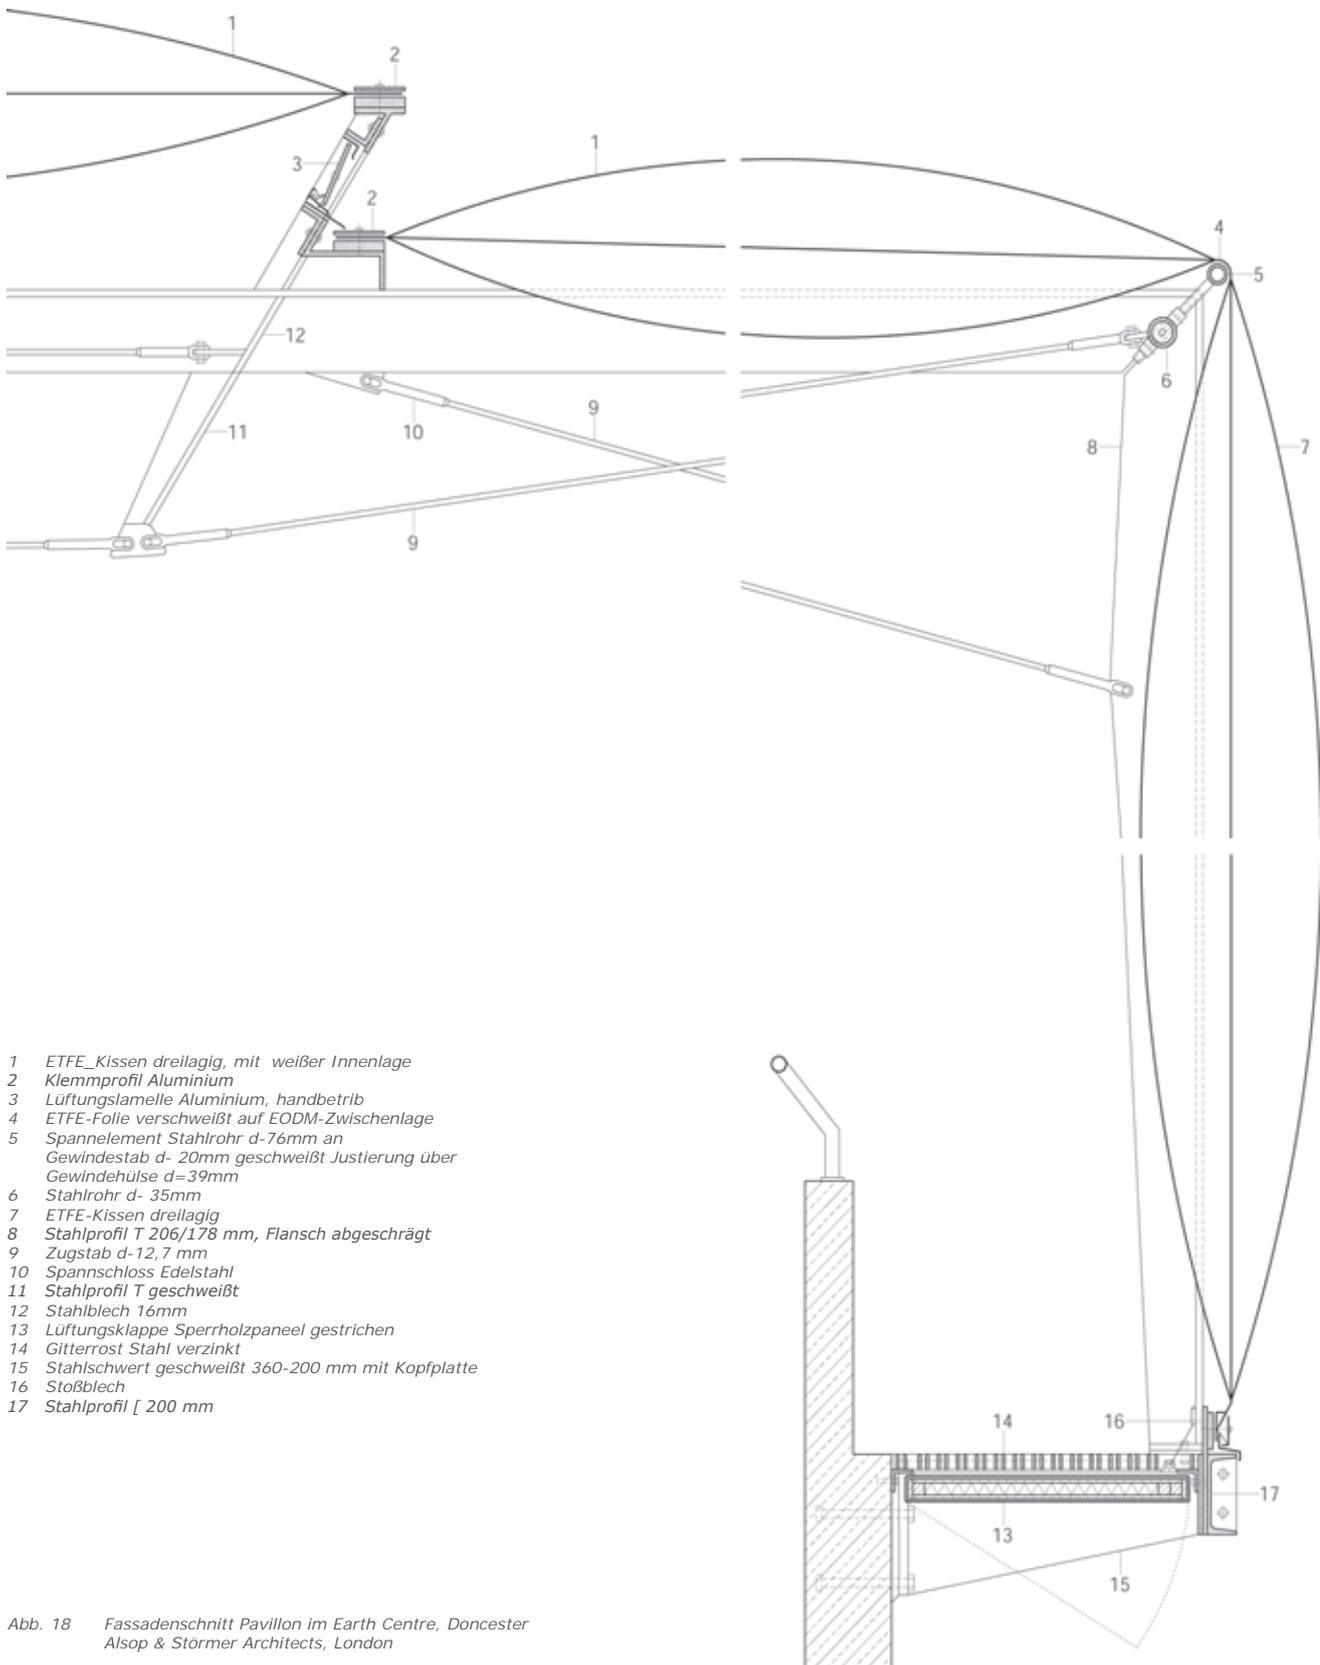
Fassadenschnitt Pavillon im Earth Centre, Doncaster
